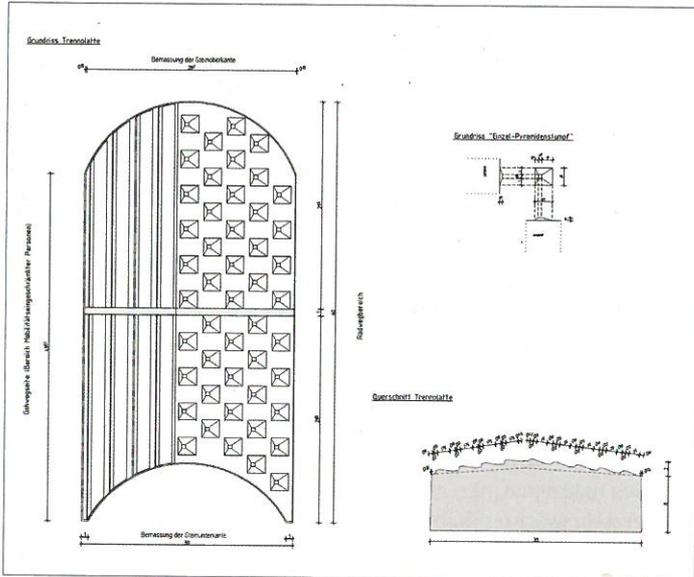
Rein konstruktiv betrachtet handelt es sich um eine an der Oberseite leicht gewölbte Betonplatte von 30 cm Breite mit einer Kantenhöhe von 8,0 cm (Profil: + 2,0 mm max.).
